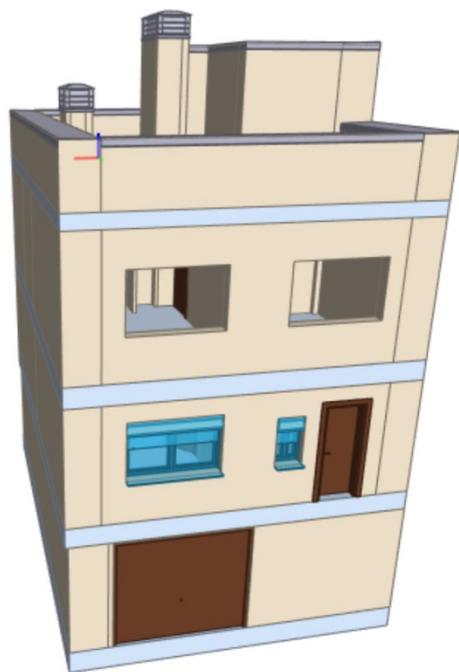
Stato avanzamento lavori Day1 prospetto Nord .
